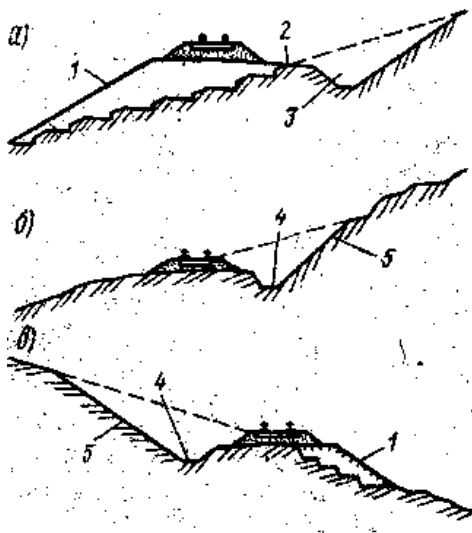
Поперечные профили: а) полунасыпи; б) полувыемки; в) полунасыпи – полувыемки; 1 – откос насыпи; 2 – берма; 3 – водоотводная канава; 4 – кювет; 5 – откос выемки.
